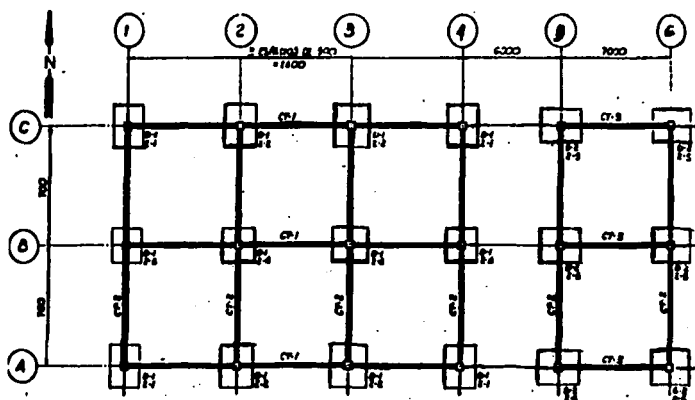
Planta de cimentación a base de zapatas aisladas, ligadas con traveses
